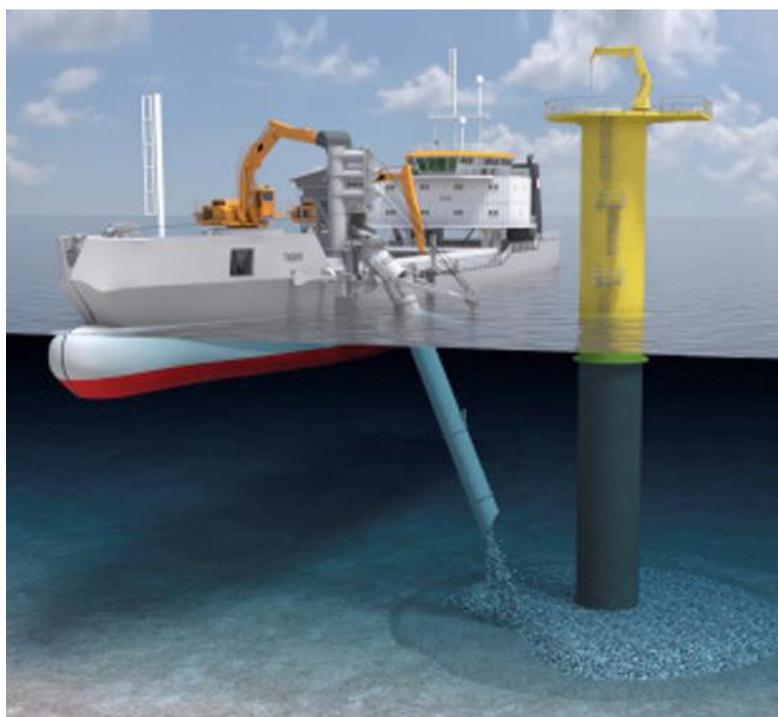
Esempio di installazione di protezione da scouring del monopalo
